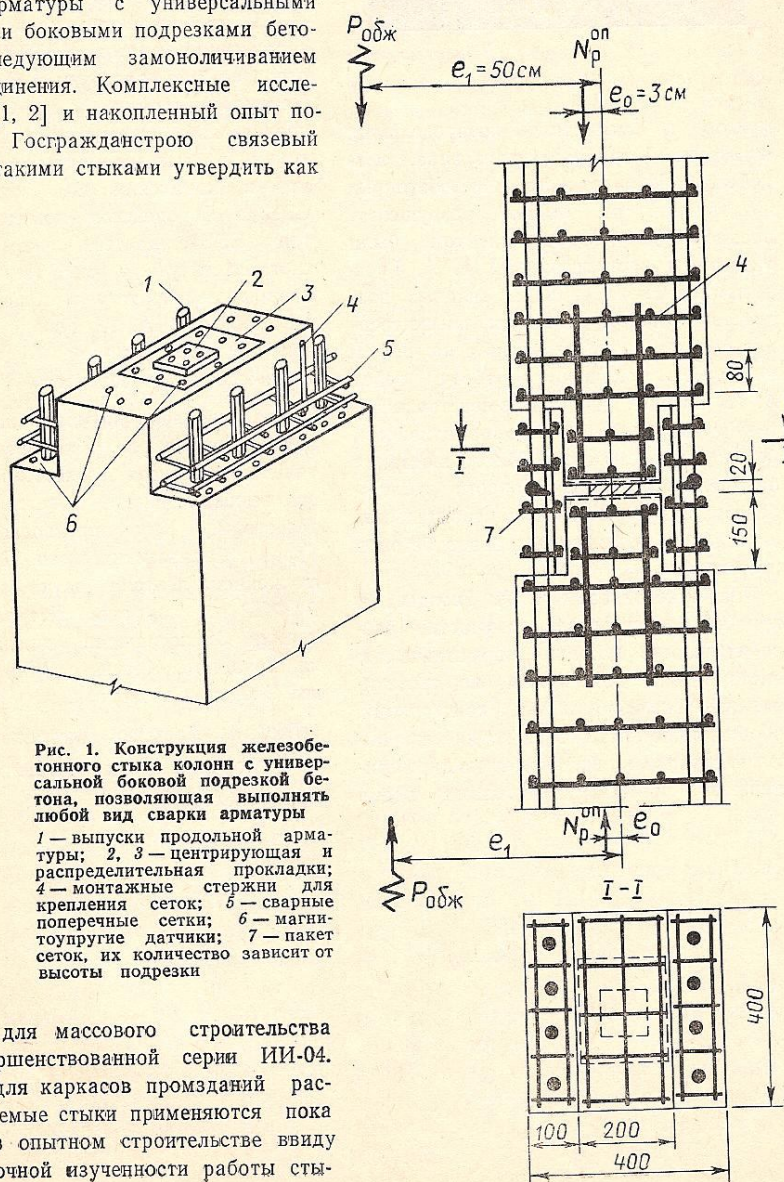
Конструкция железобетонного стыка колонн с универсальной боковой подрезкой бетона, позволяющая выполнять любой вид сварки арматуры
